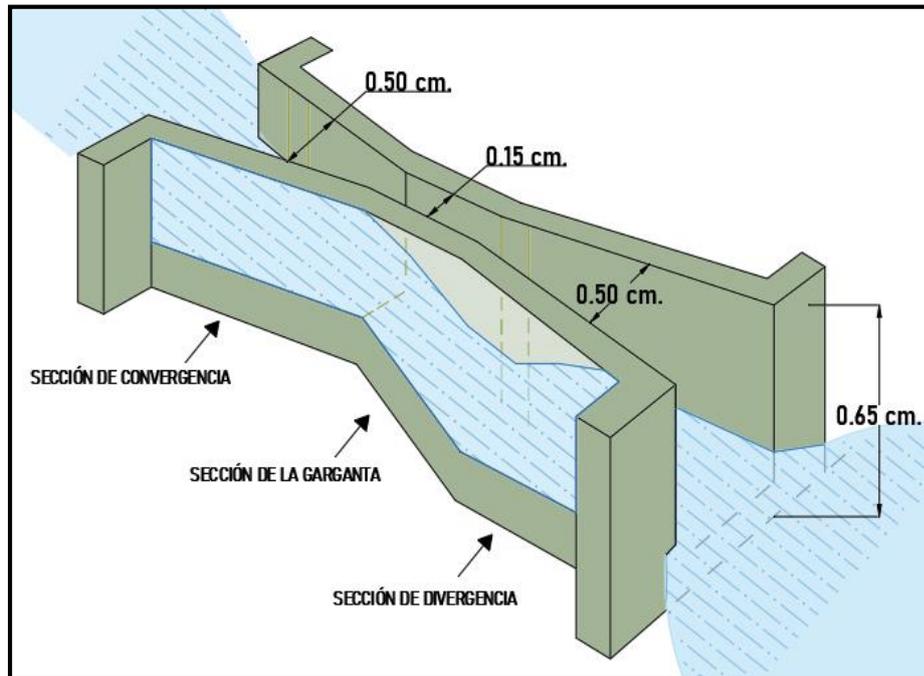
Vista isométrica de la canaleta de Parshall. Fuente: Elaboración Propia
